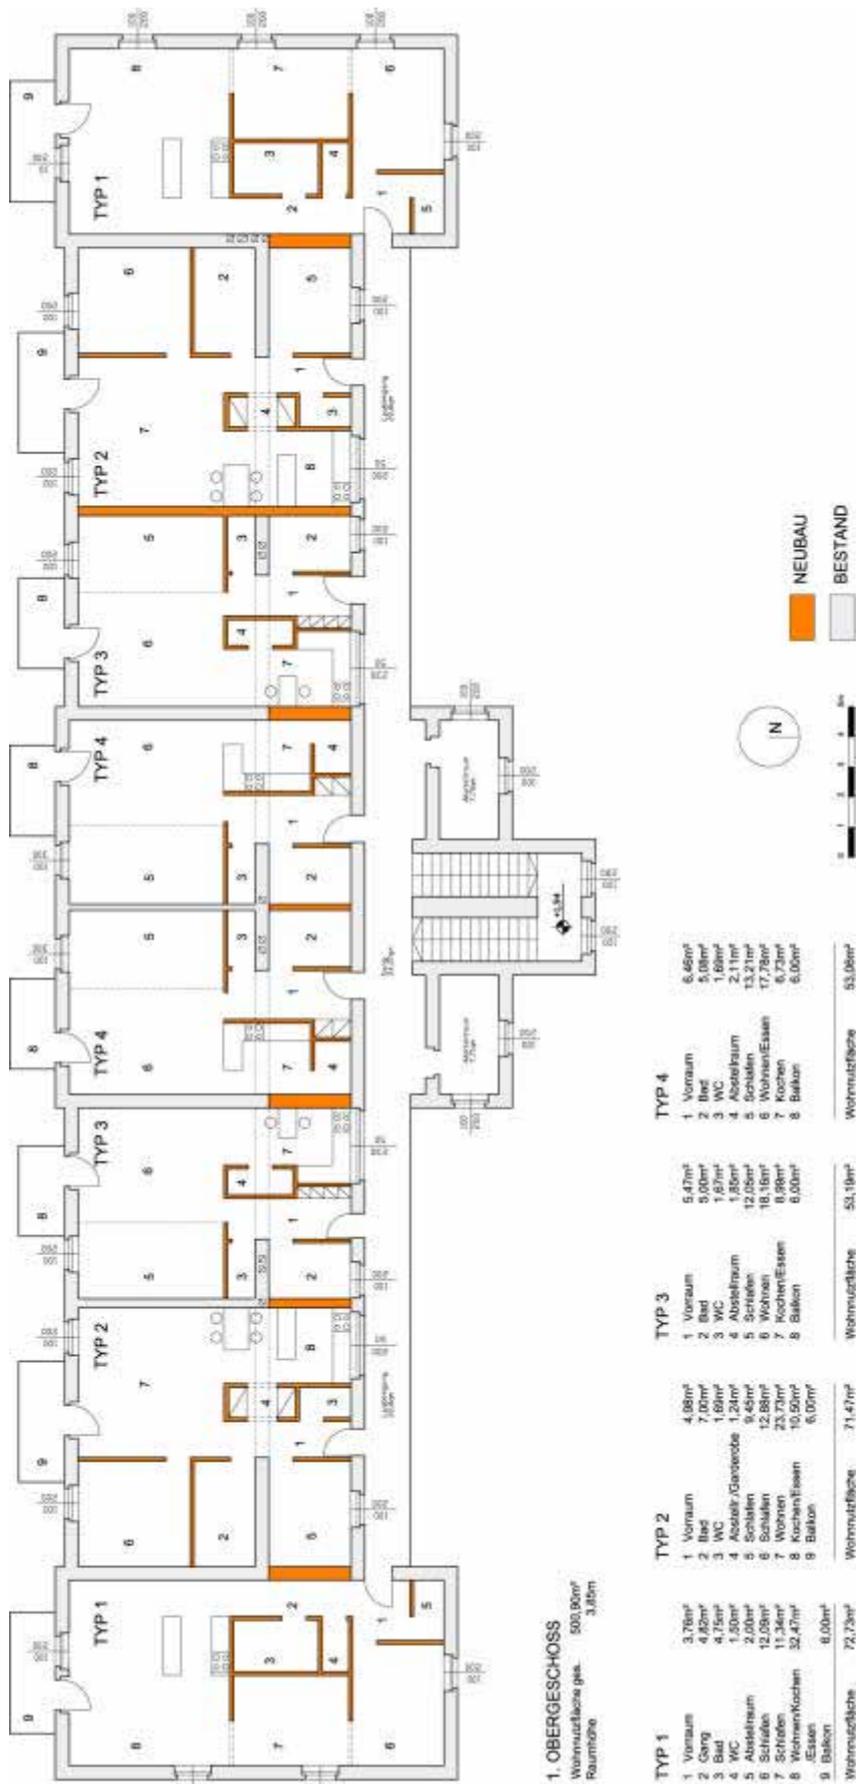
Grundriss 1.Obergeschoss
